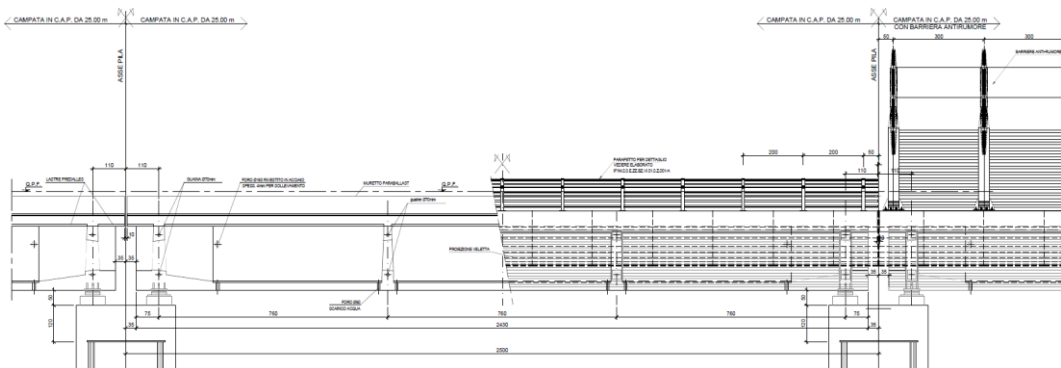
Sezione/vista longitudinali dell'impalcato tipo
